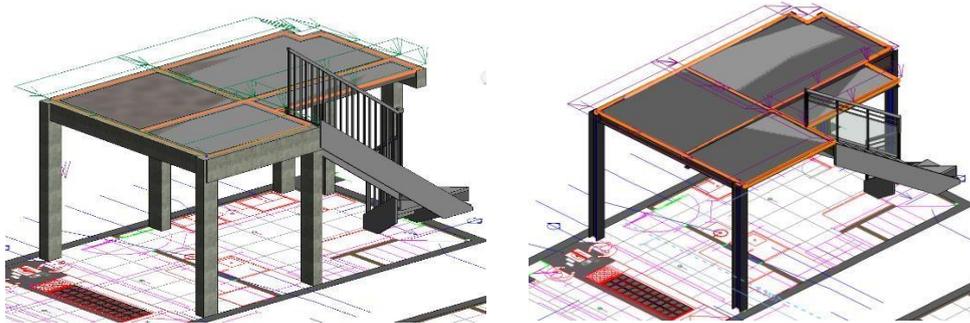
Modelo analítico das estruturas em concreto armado (à esquerda) e em aço (à direita).
